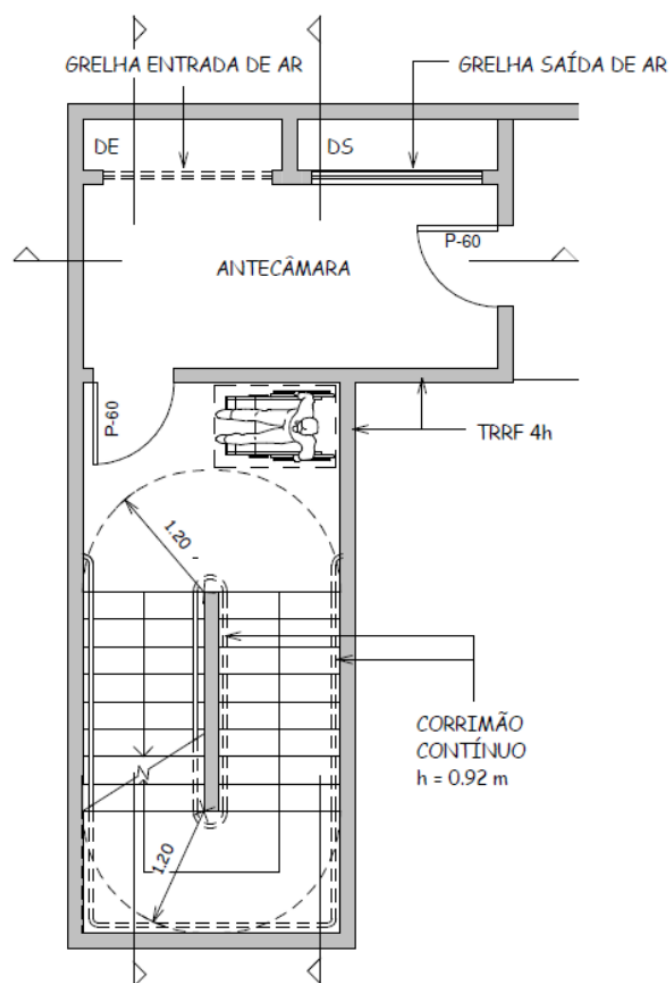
B - Escada à prova de fumaça - pavimento intermediário (planta baixa).
